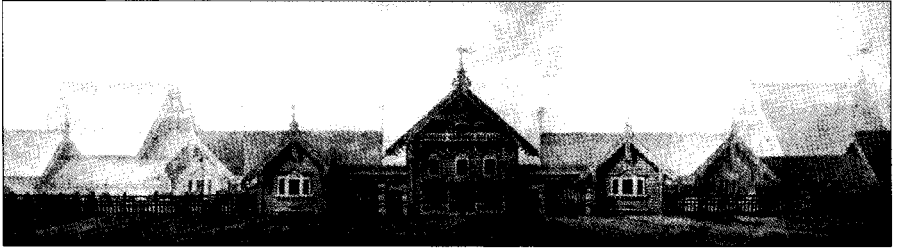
Glasowo. Fassadenansicht Variante 1, Carlo Rossi 1815.
